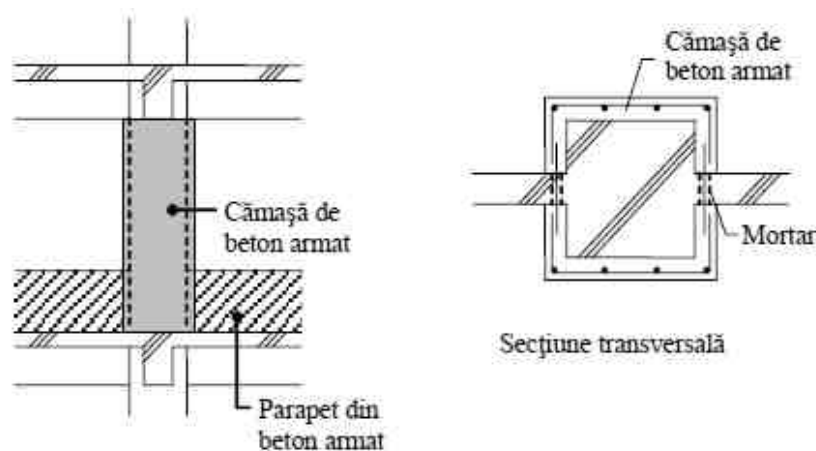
Camasuire stâlp adiacent parapete din beton armat (P100-3/2008)
